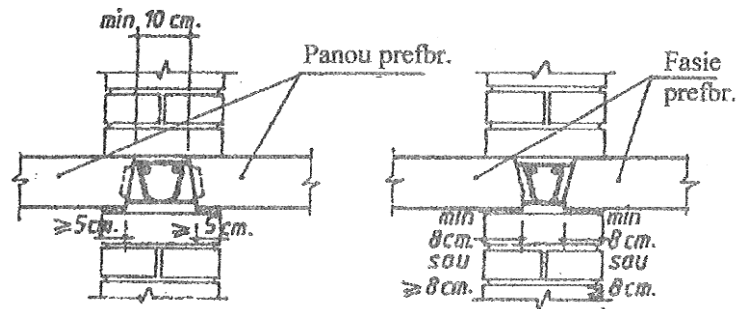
Planșee din elemente prefabricate din beton armat
